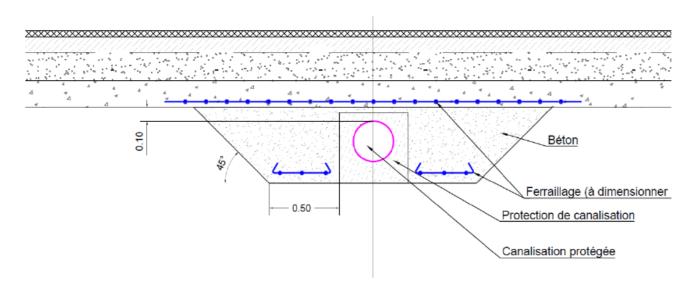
coupe longitudinale de plateforme sur zone de pontage d'un réseau transversal
